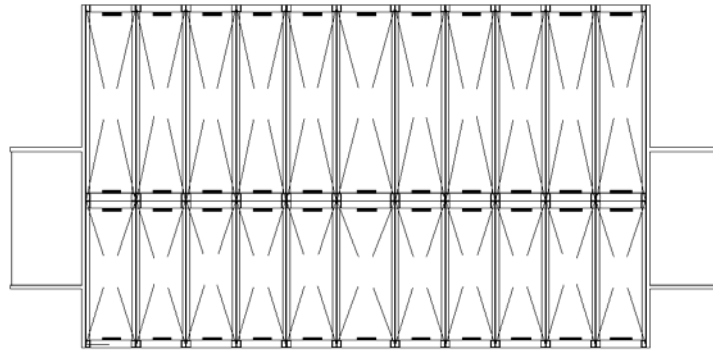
Vista de planta tipo torre A, disposición de los módulos Variel.
